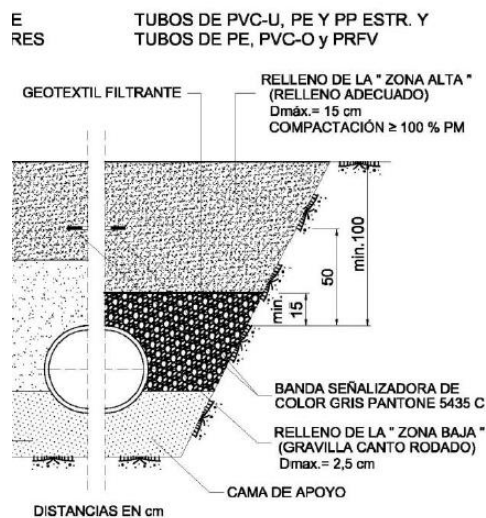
Sección tipo de zanja en bajo cruce o viario
